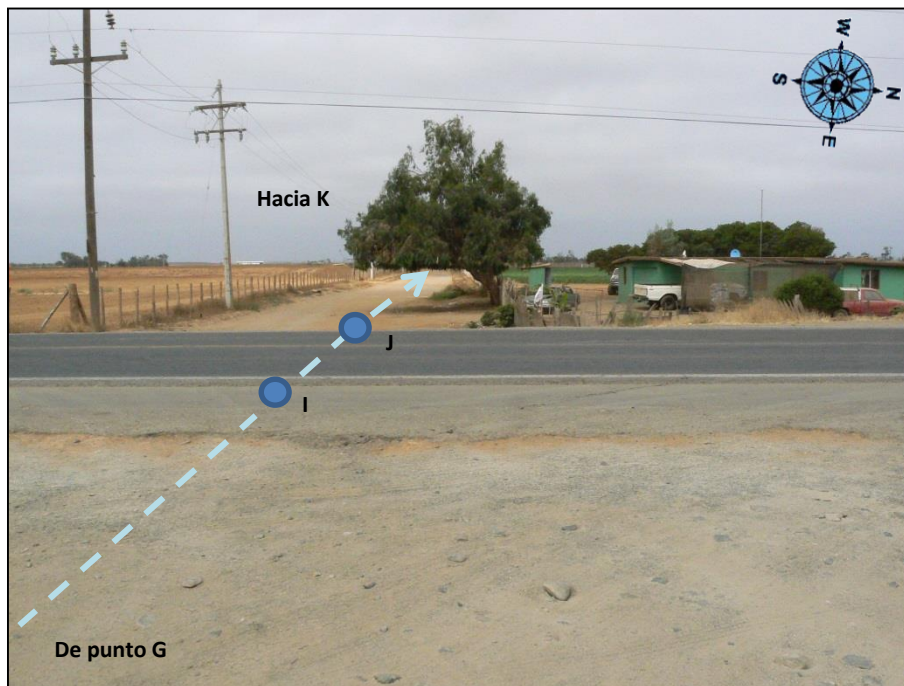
Vista hacia el este del tramo I-J en donde se observa claramente la Carretera Transpeninsular y parte de la siguiente sección de la tubería (J-K).
